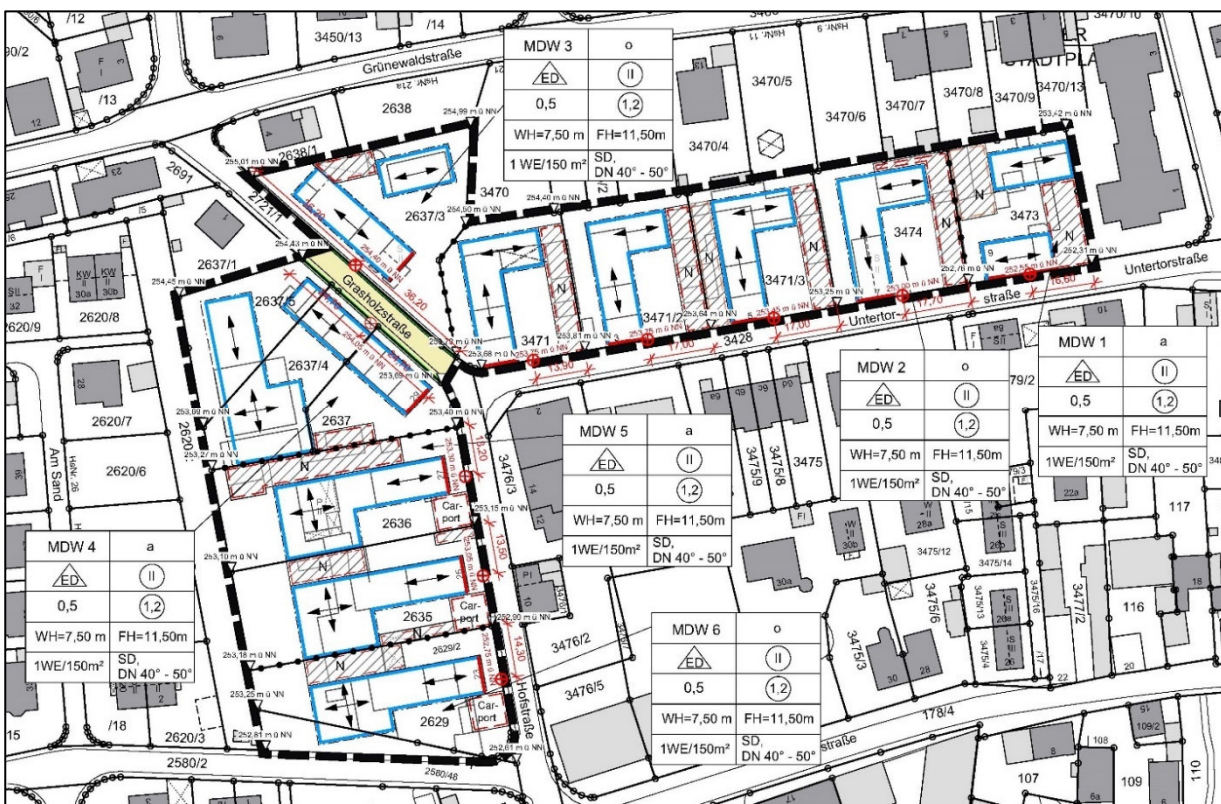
Planzeichnung der 1. Bebauungsplanänderung „Bauernsiedlung“
